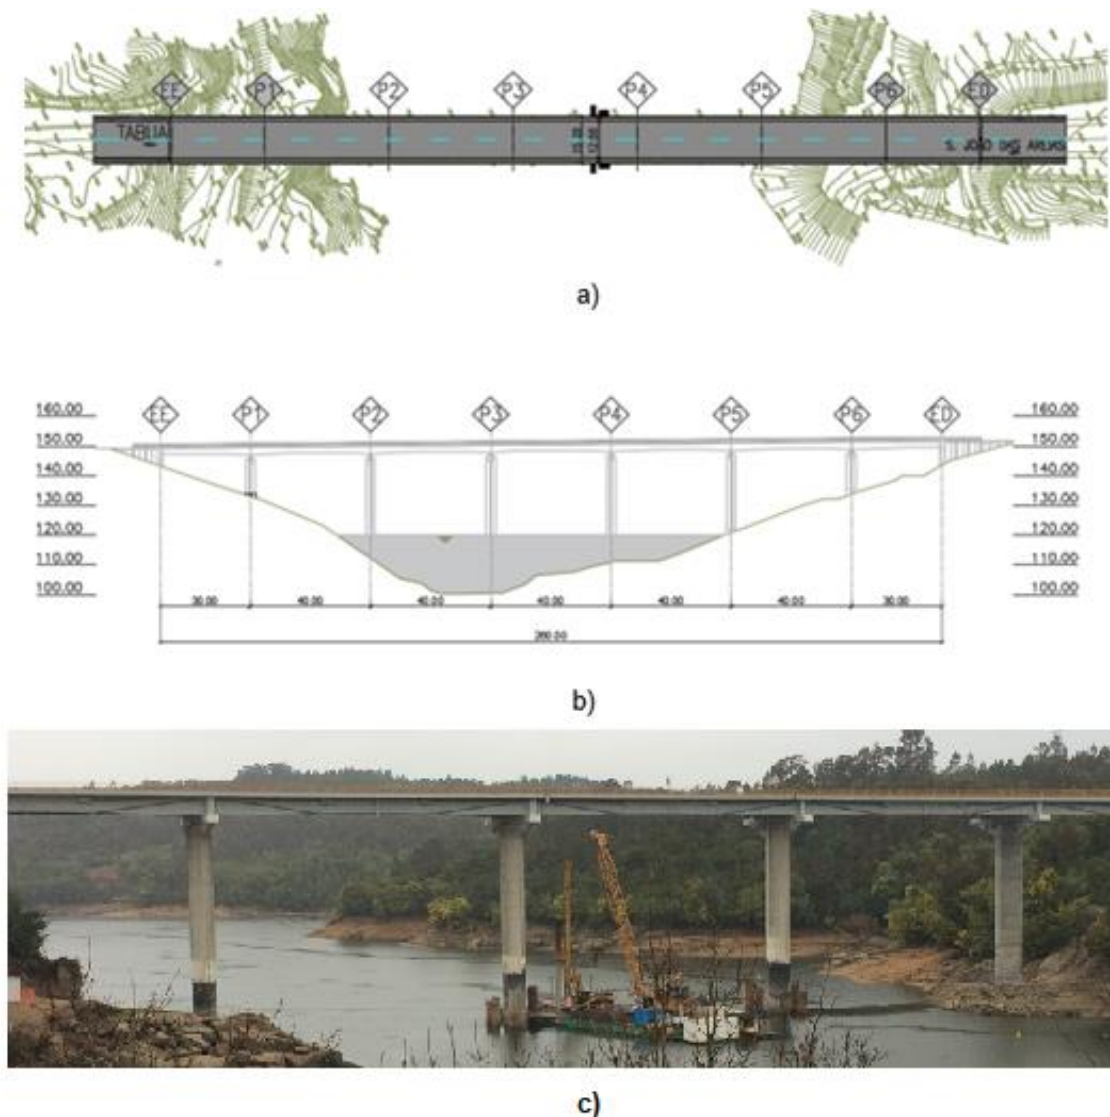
Planta (a), alçado (b) e fotografia da obra (c) da ponte de São João das Areias
